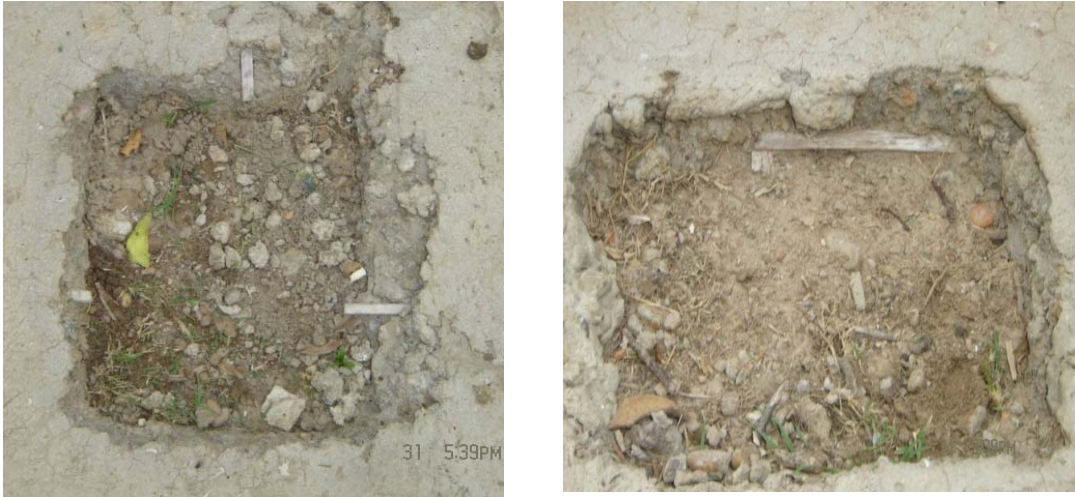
Detalle del piso reforzado con tirillas de palma de lata
